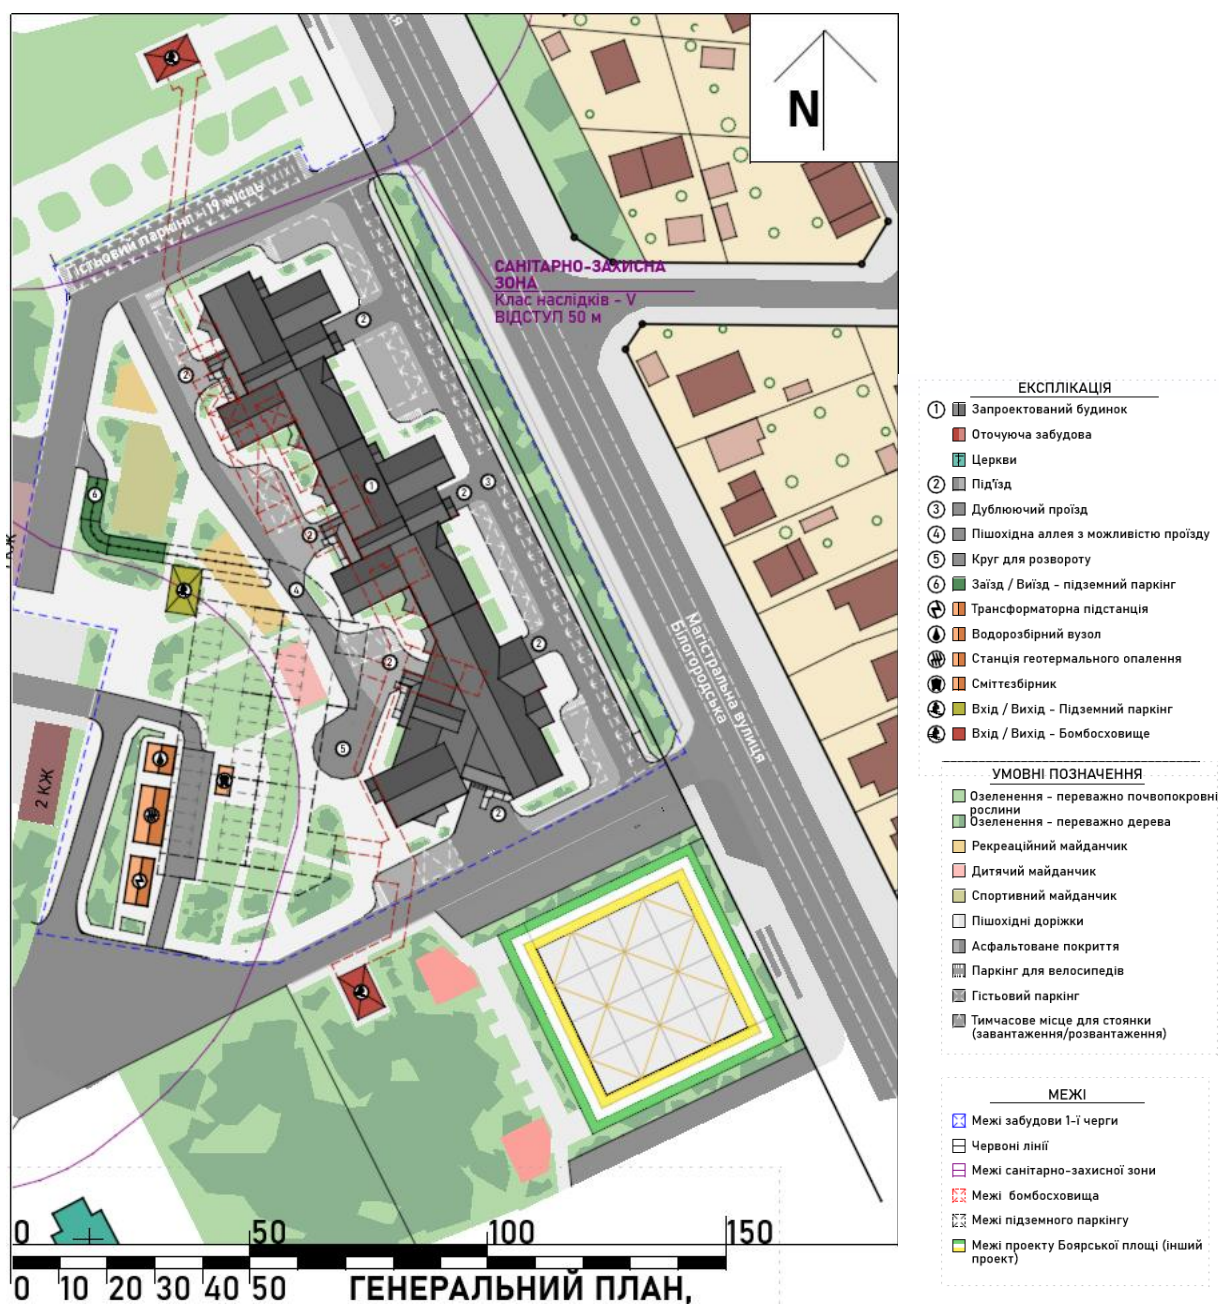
Генеральний план ділянки та оточуюча забудова [5]
